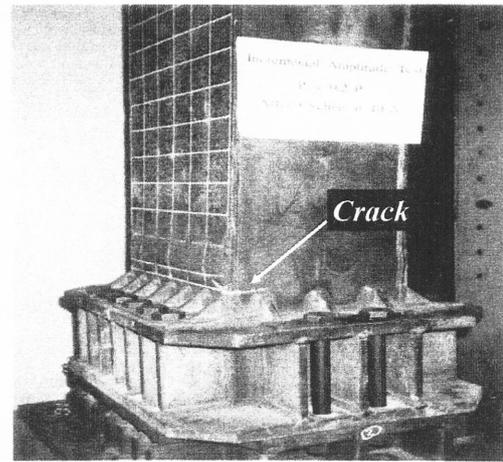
3角リブ付き橋脚基部とベースプレート溶接部の割れ（実験）
